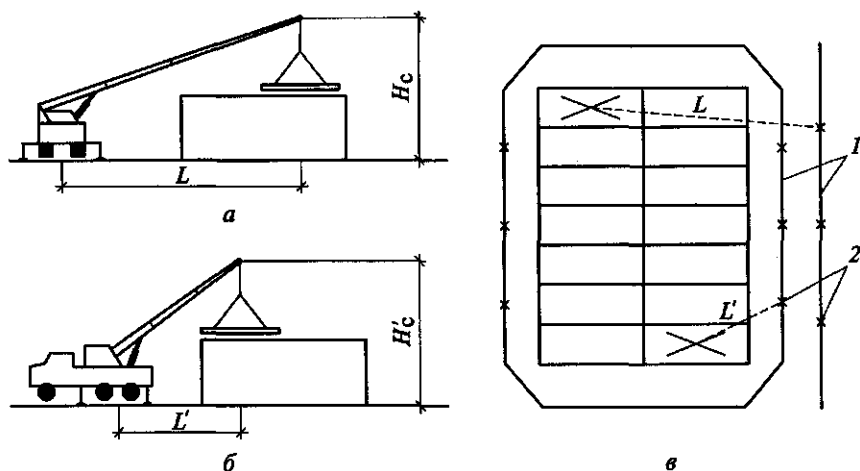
Схемы монтажа панельного перекрытия краном:
